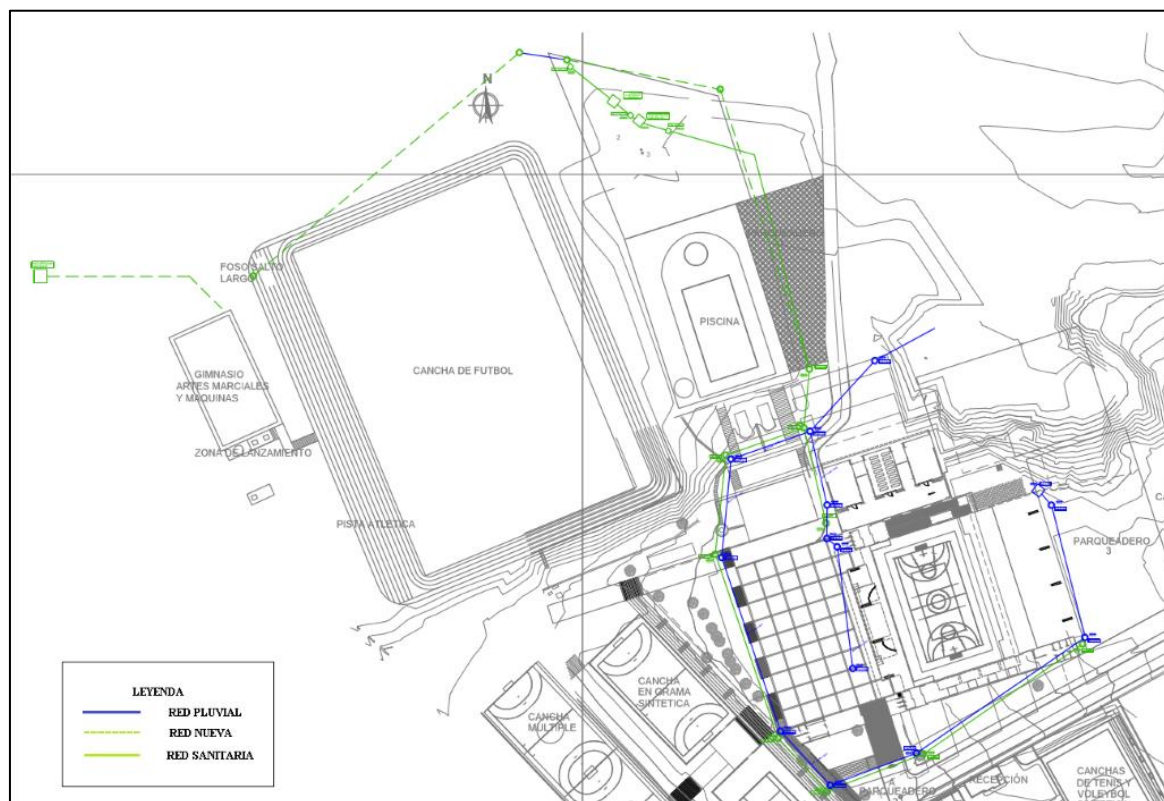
Distribución de la red de alcantarillado - Campus Piedecuesta.
